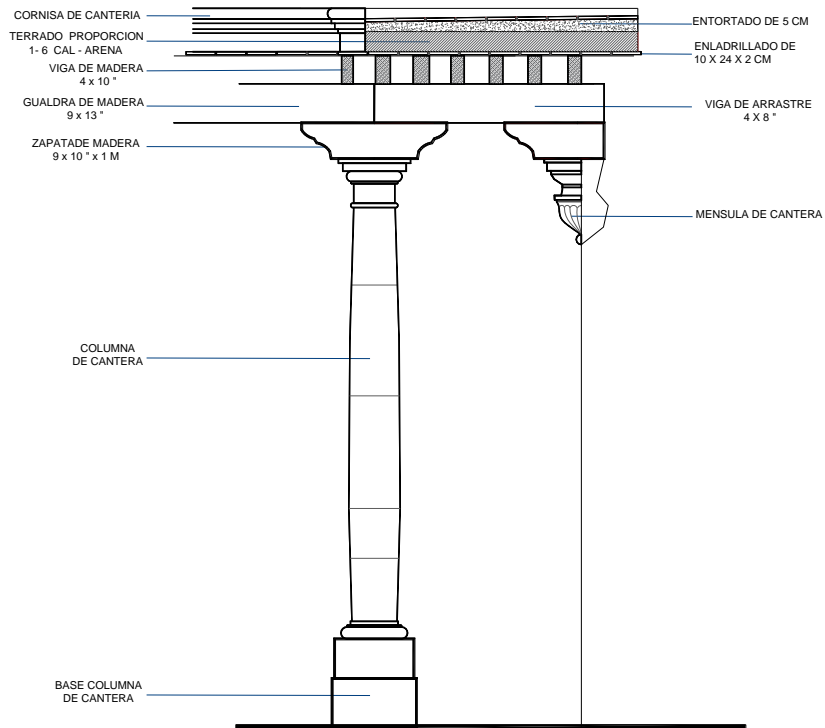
Detalle No. 4 vista del corte del apoyo aislado de la cubierta del corredor.
